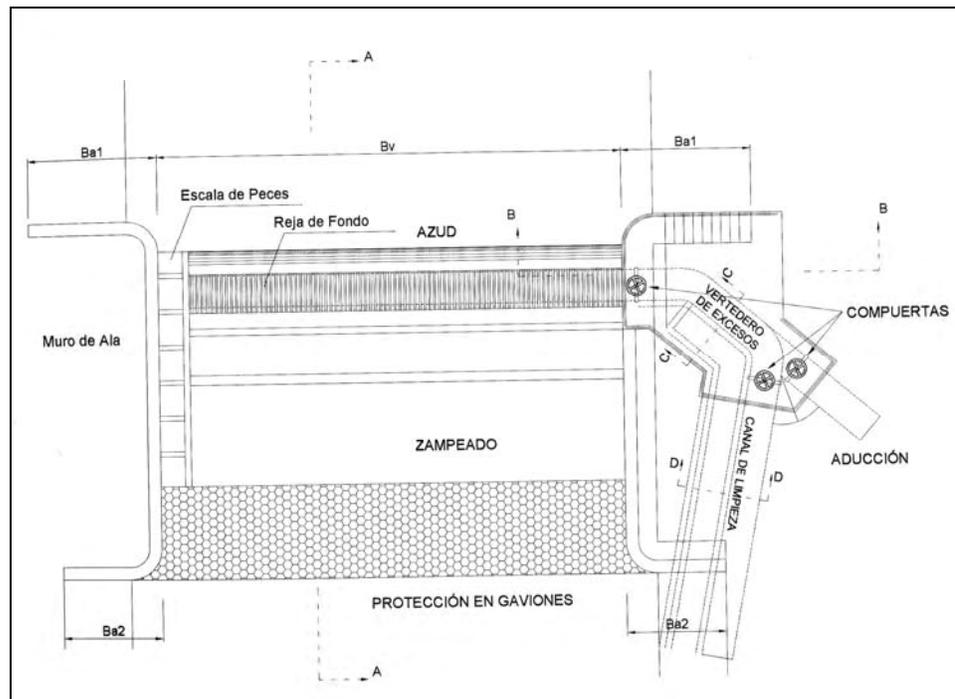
Vista en planta de la Captación con Reja de Fondo
